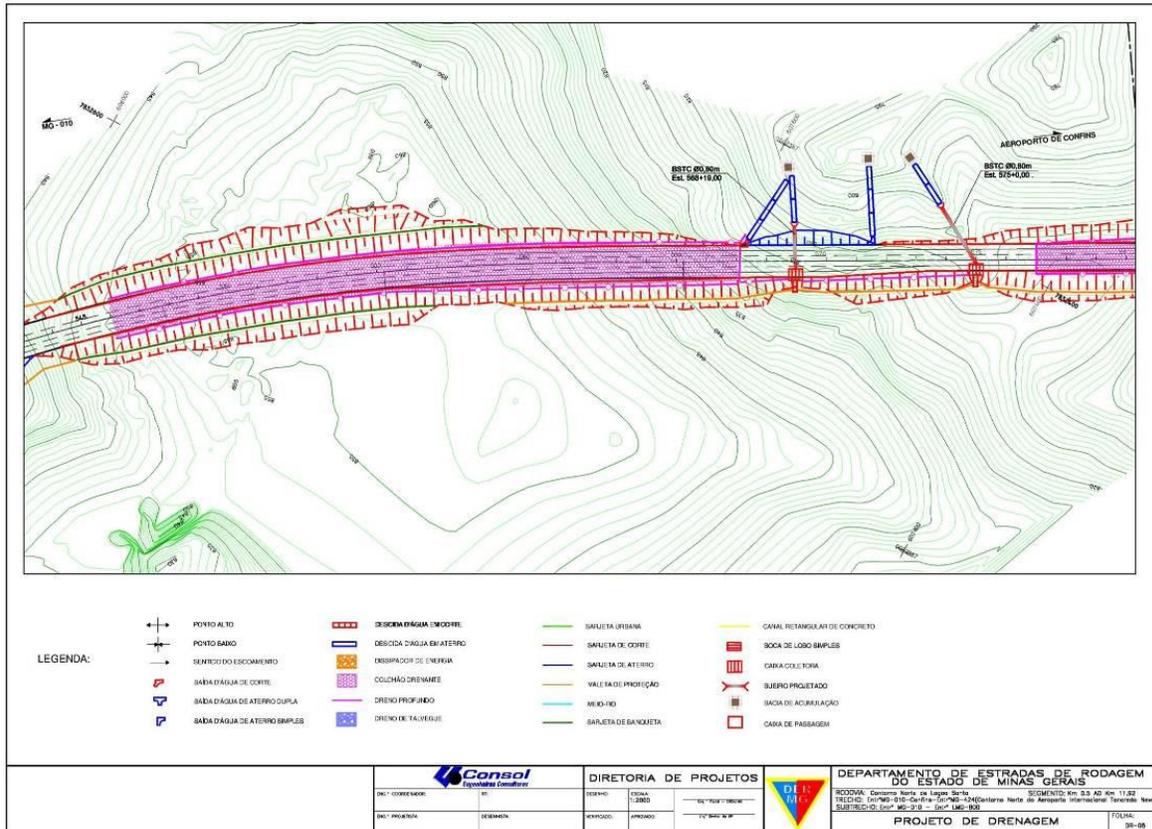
Projeto de drenagem pluvial de trecho do traçado do Contorno Norte de Lagoa Santa.
